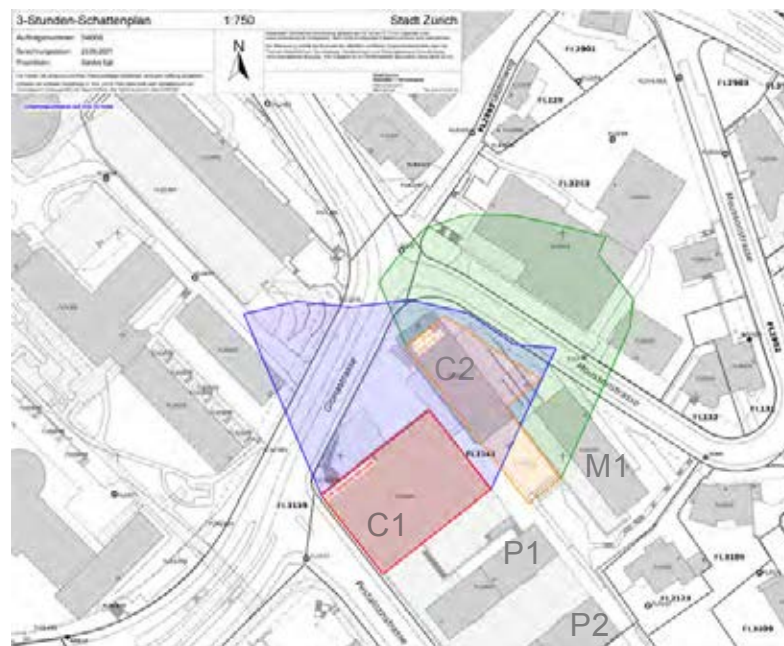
3-Stunden-Schattenplan (skaliert), Stadt Zürich Geomatik + Vermessung (Beschriftungen Planpartner; vgl. Anhang A5)
